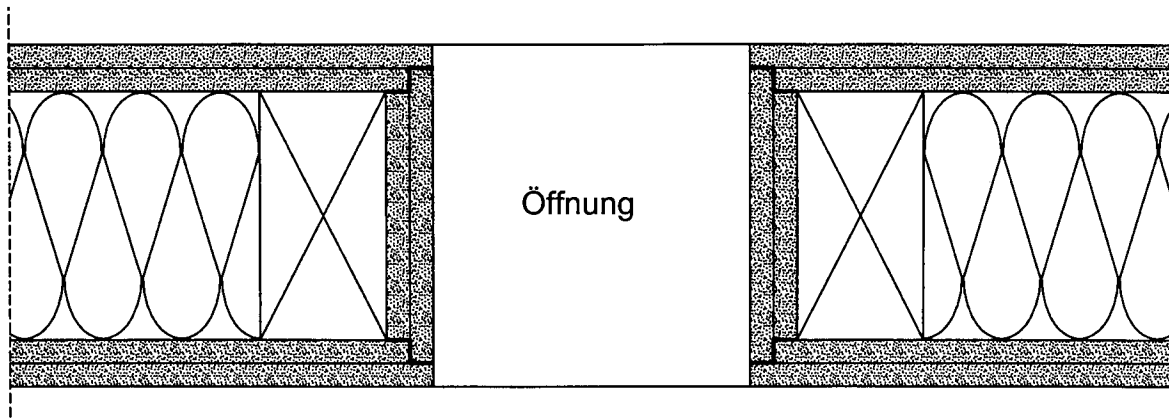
Fugenversatz senkrecht zur Bauteilebene (planmäßige Öffnung)
